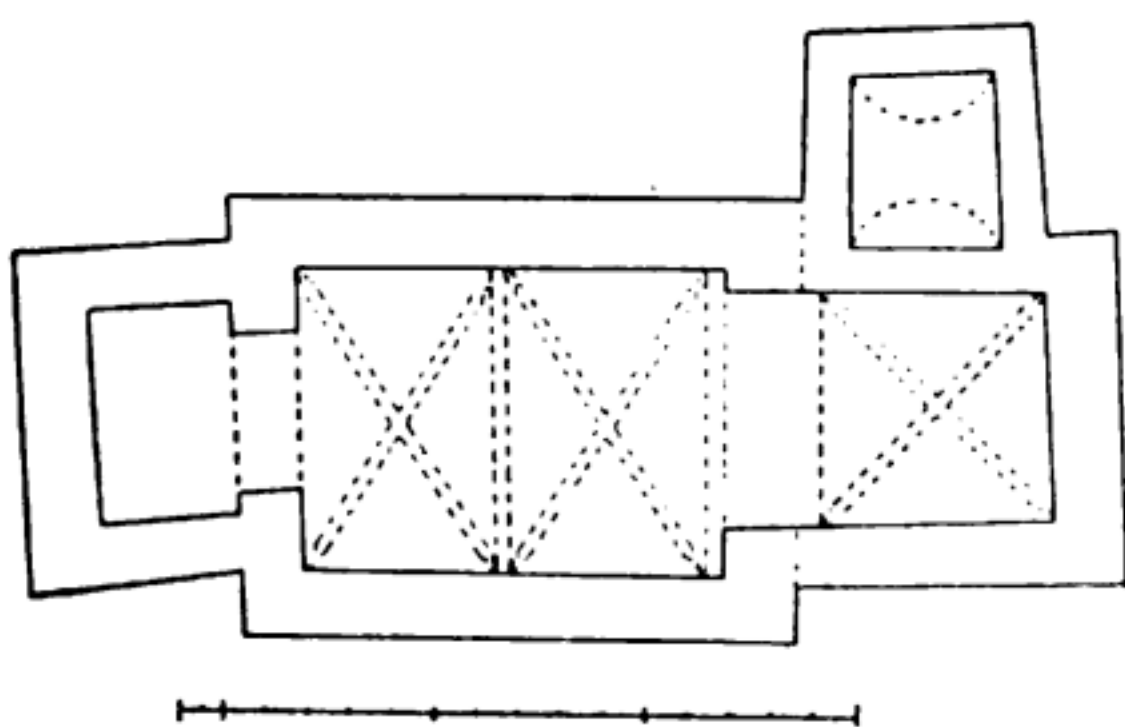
Haga. Rekonstruktion af antagen tidigare plan och hvalfsystem.
